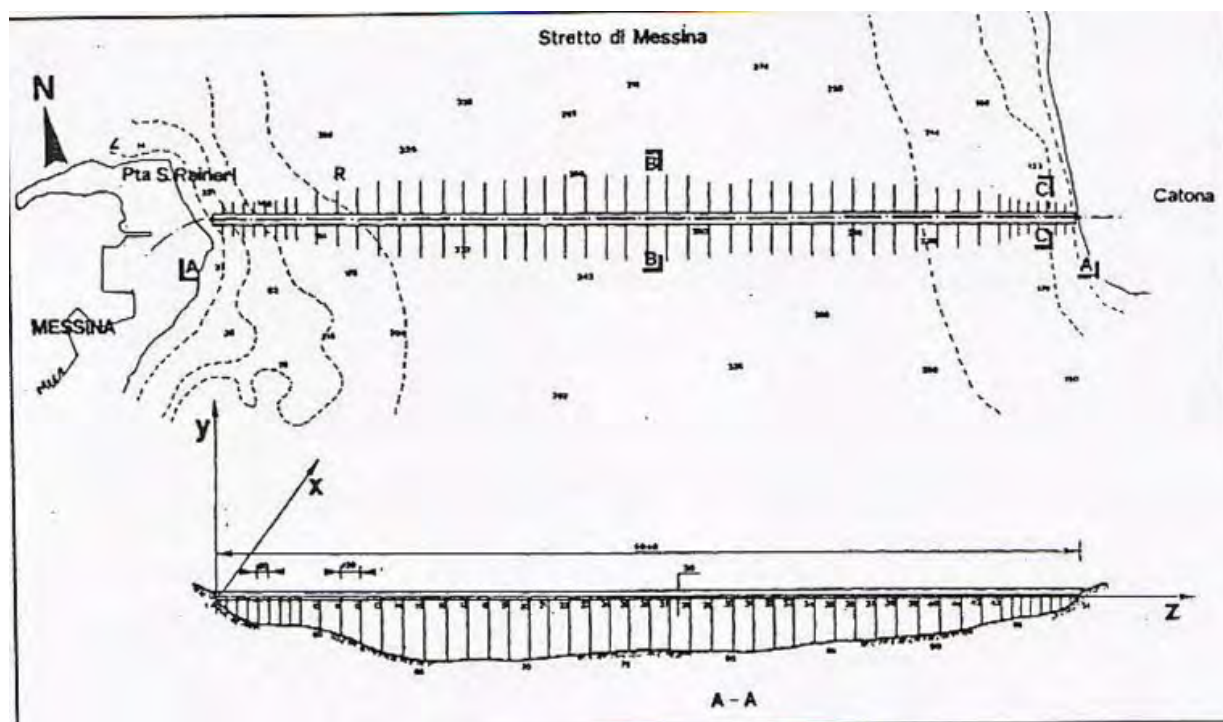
Prospetto e planimetria del progetto del 1984-1988 "Società Ponte di Archimede nello Stretto di Messina"<sup>222</sup>
